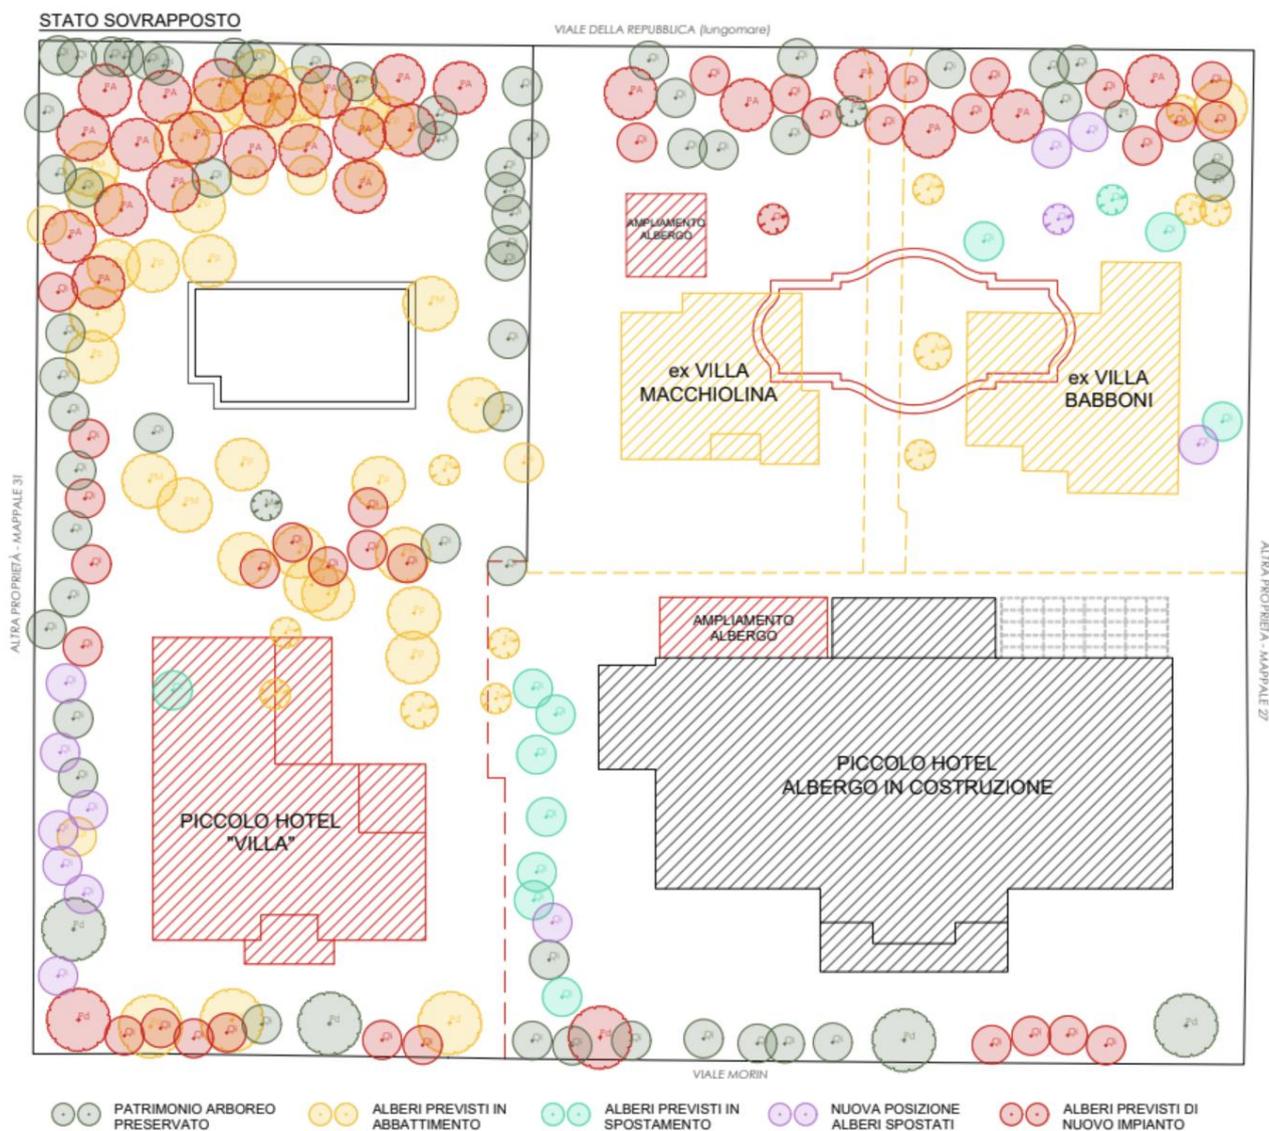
Estratto tav. SPX03 – Progetto verde e alberature- Stato di Progetto e sovrapposto
